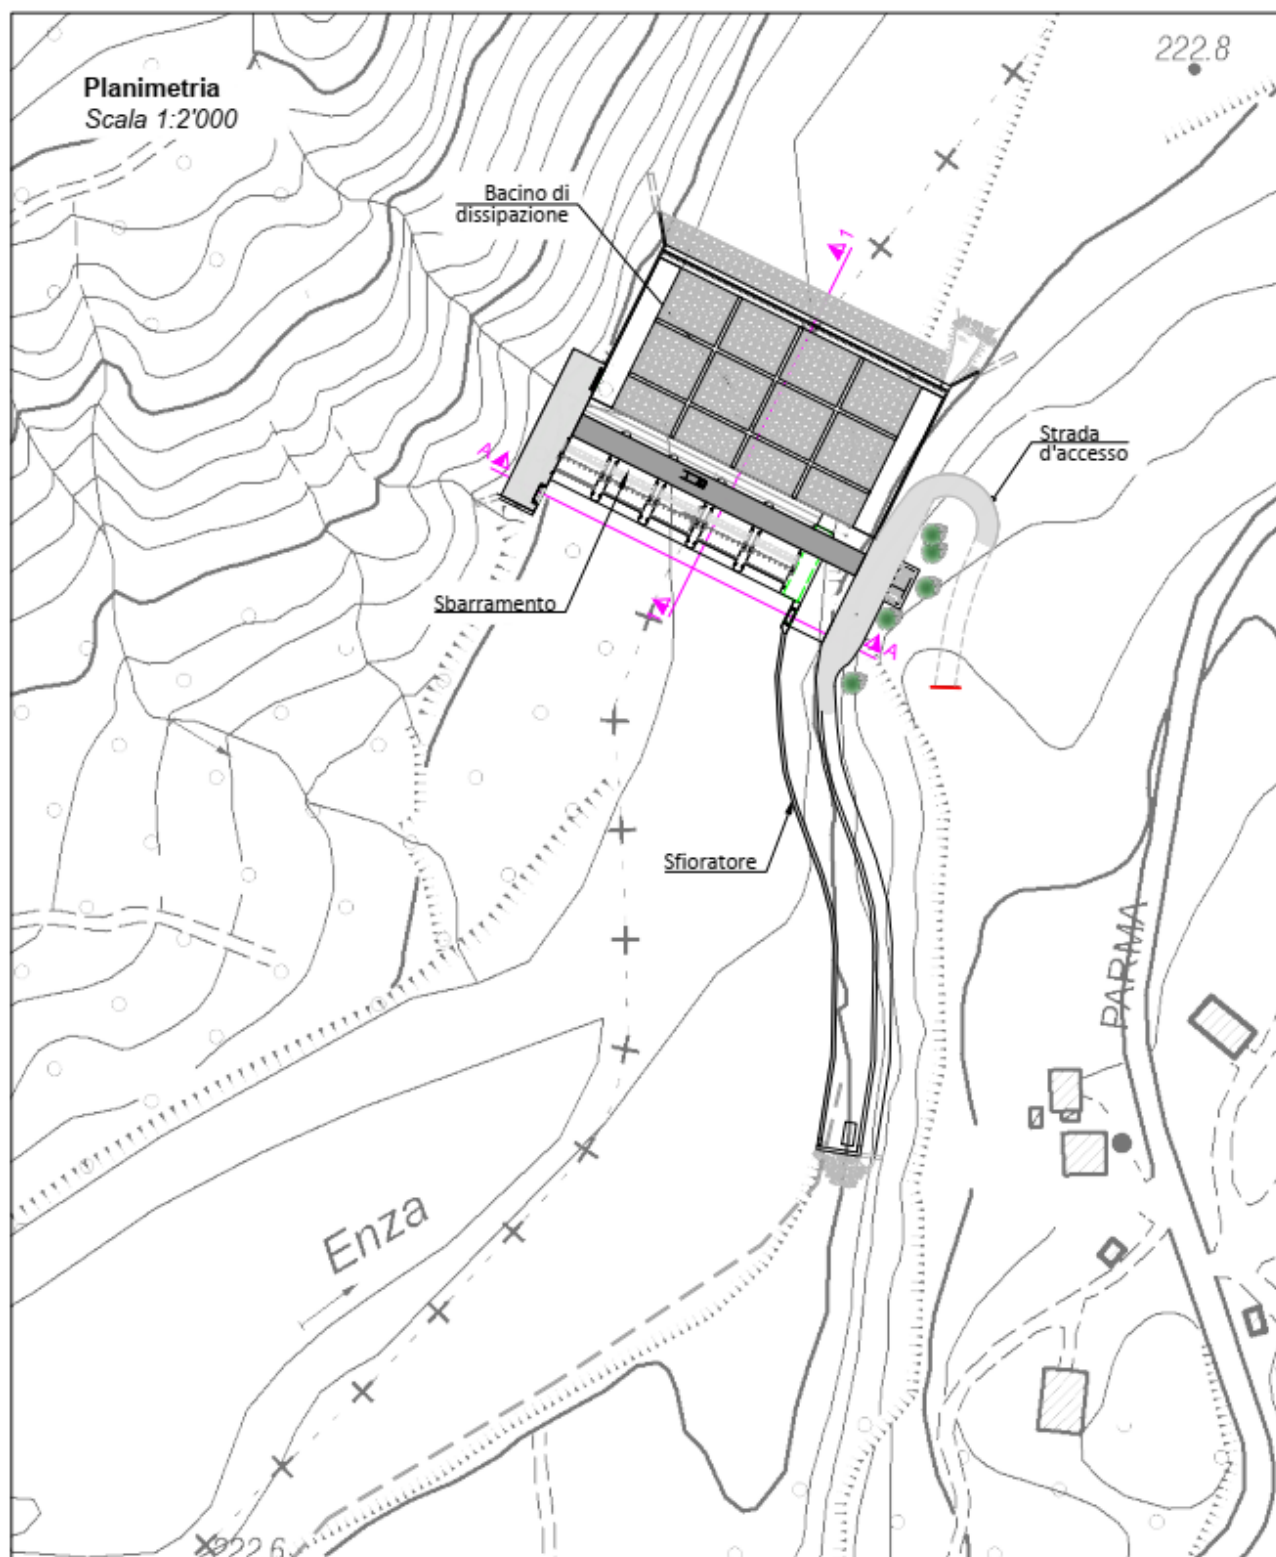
estratto della planimetria di progetto invaso 2 - CURRADA
